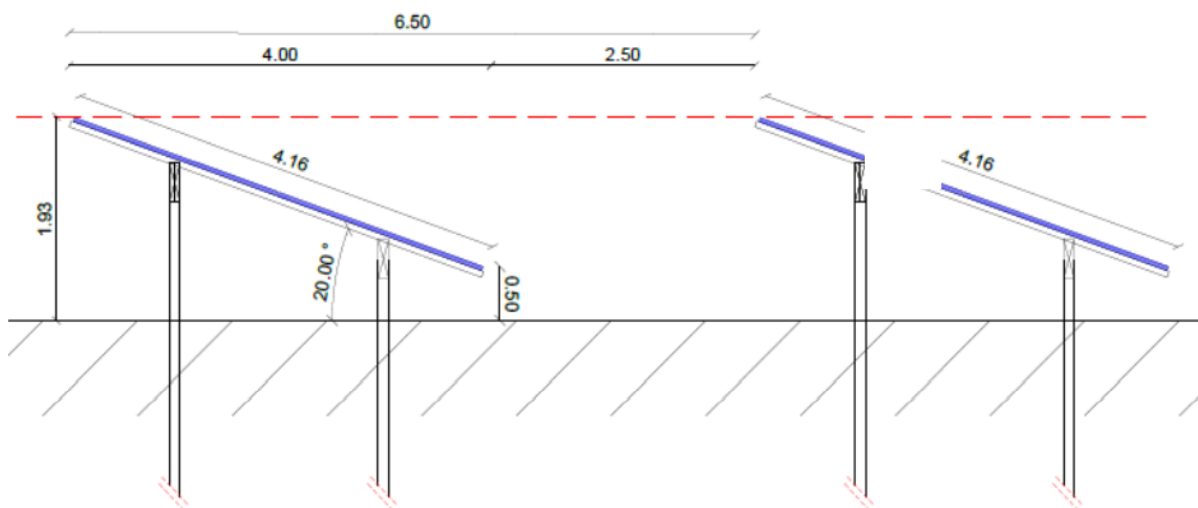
Exemple de plan de coupe pour l'implantation avec des pieux battus
